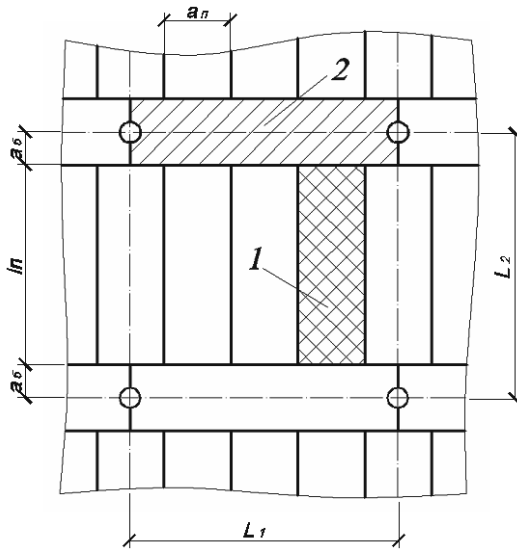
Фрагмент сталезалізобетонного безбалкового перекриття:
